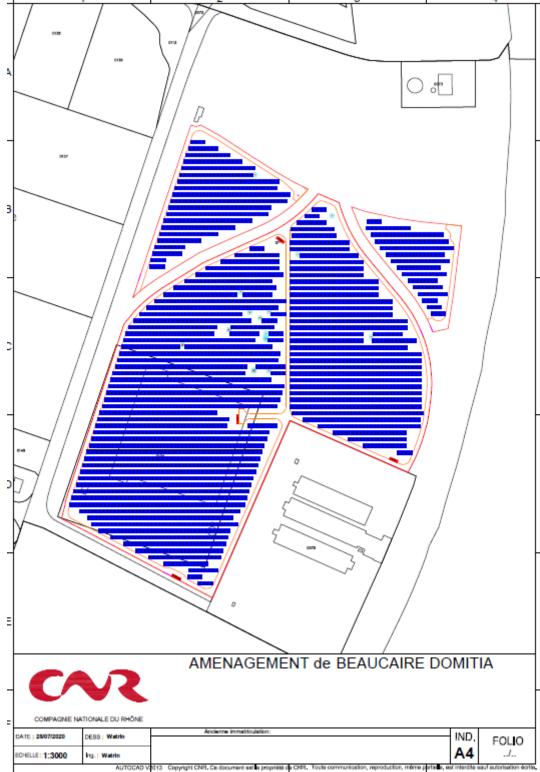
Plan de masse de la variante 2 (juillet 2020)
